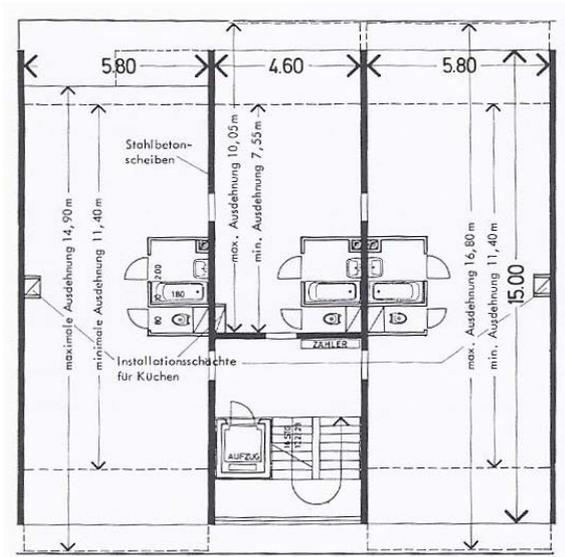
festgelegte Einbauten im Grundriss
